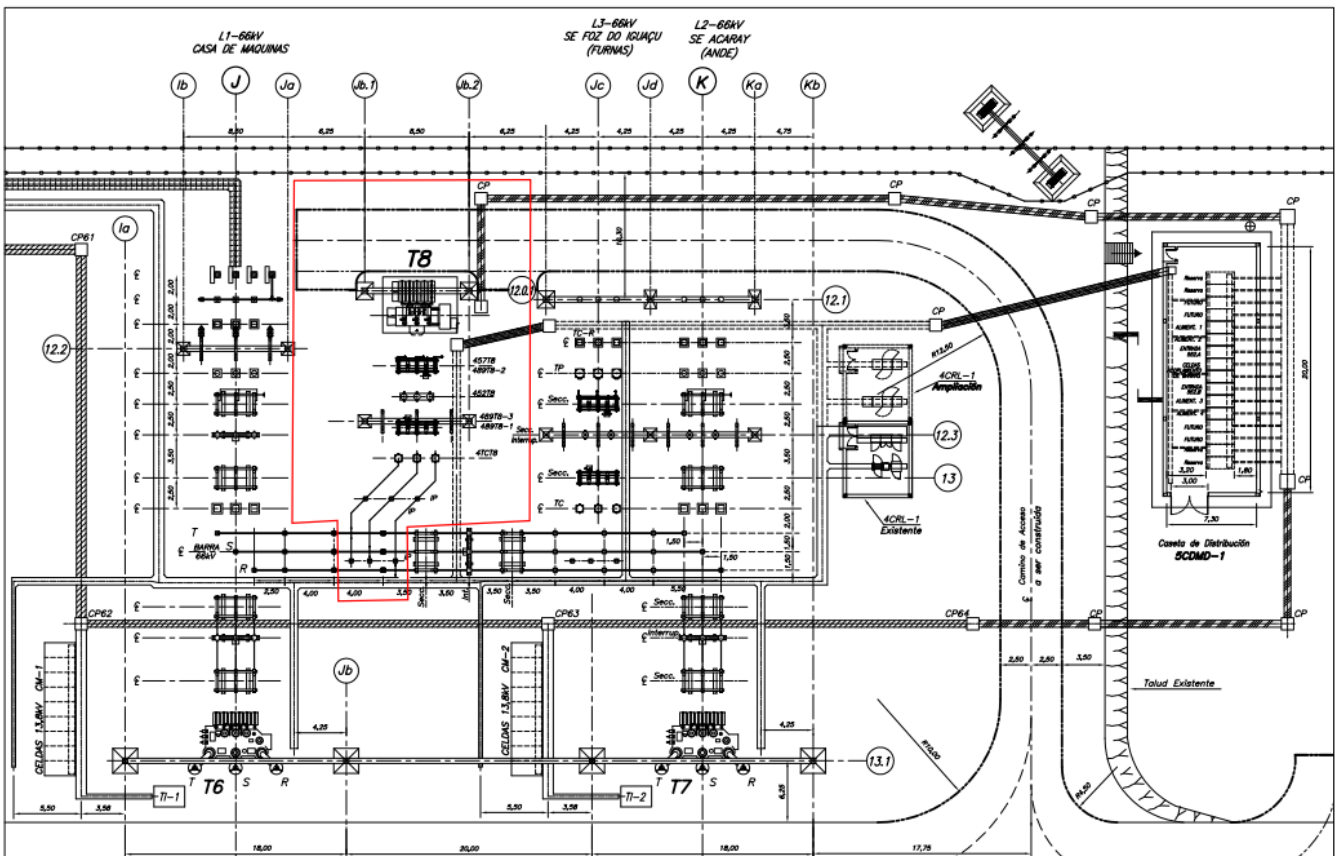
Celda T08 66kV – Planta - Solución Convencional
